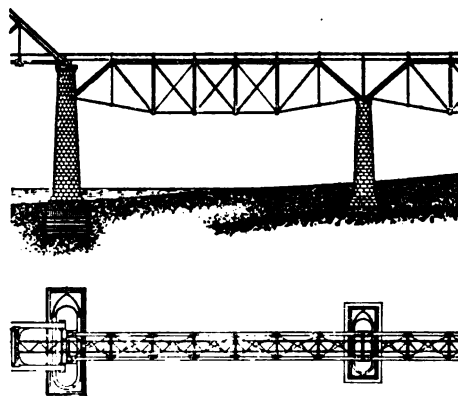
Travées de 53^m,09 du pont sur l'Ohio.
